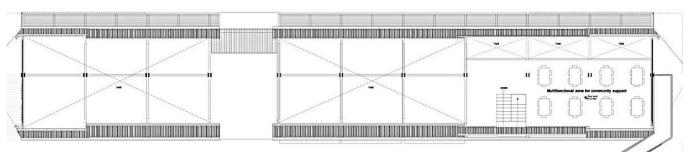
Planta alta del Centro de Capacitación Indígena Entre Nos Atelier por el Arquitecto Adolfo Mejía. Fuente: http://www.archdaily.mx/. S/E
